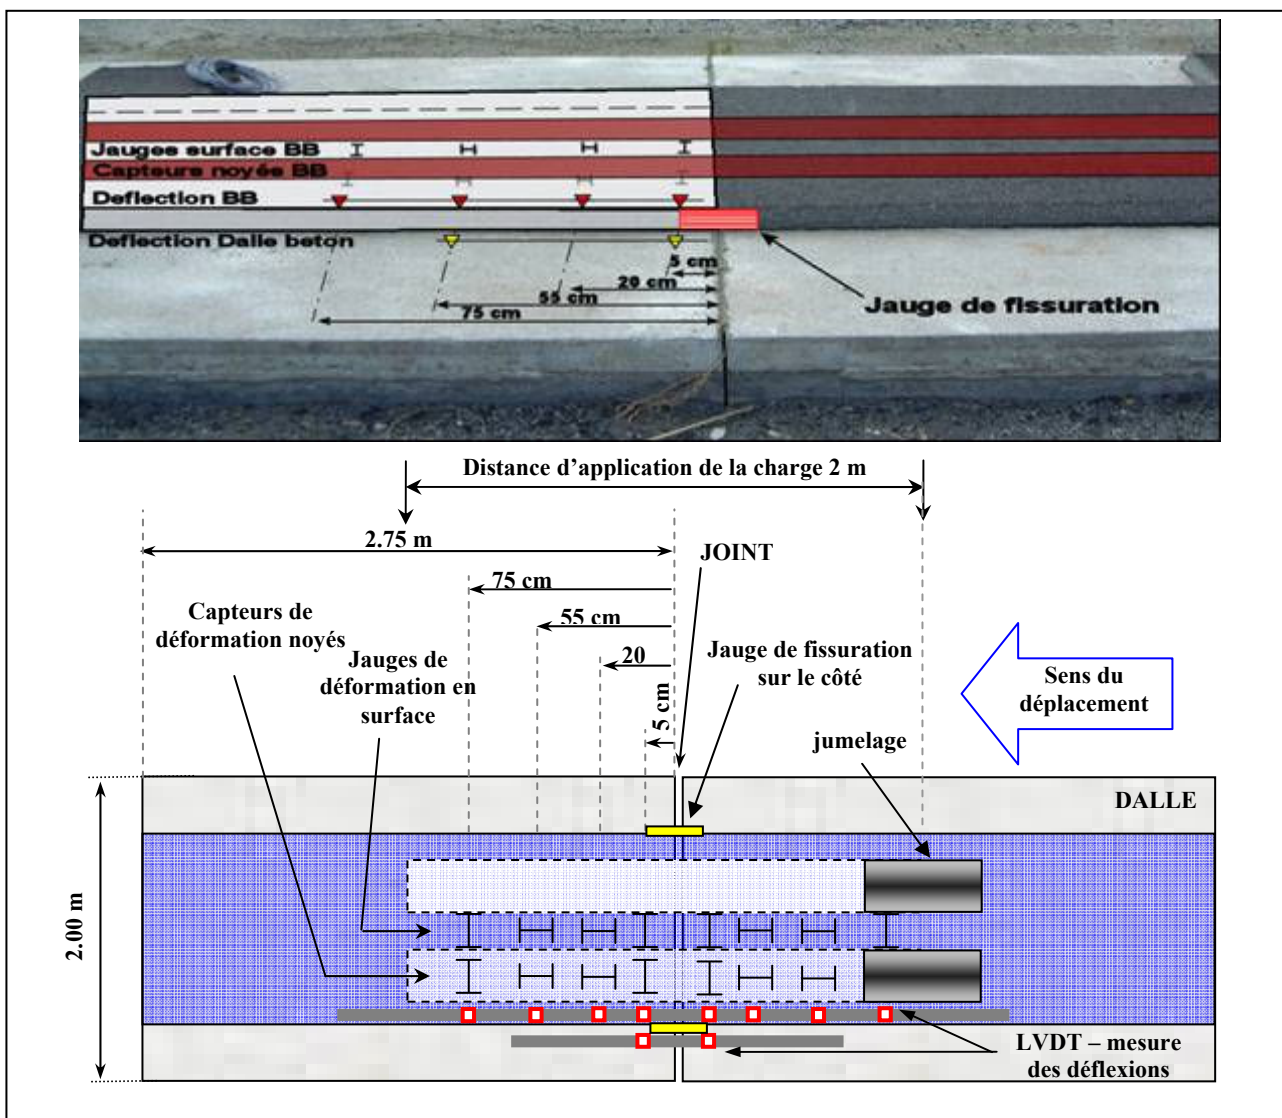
Schéma de l'instrumentation prévue pour chaque joint pour l'essai de fissuration avec Fabac (type de jauge et position)
